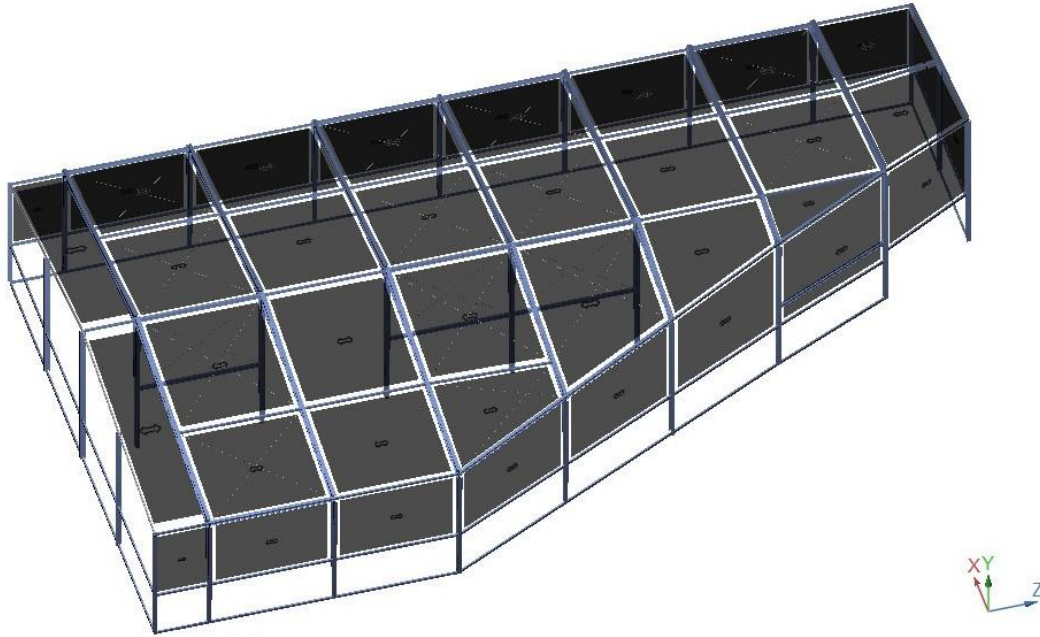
Estructura de planta trapecial de 40.30 m de ancho x 72.13 m de largo a ejes con 10.80 m de altura a rodilla
